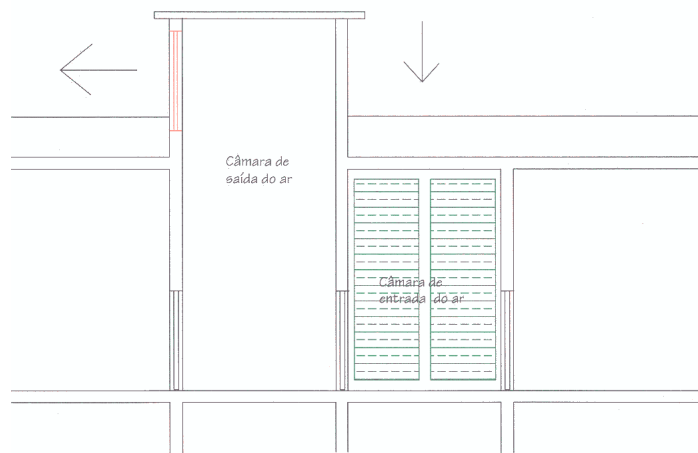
Corte vertical das câmaras de entrada e saída de ar
